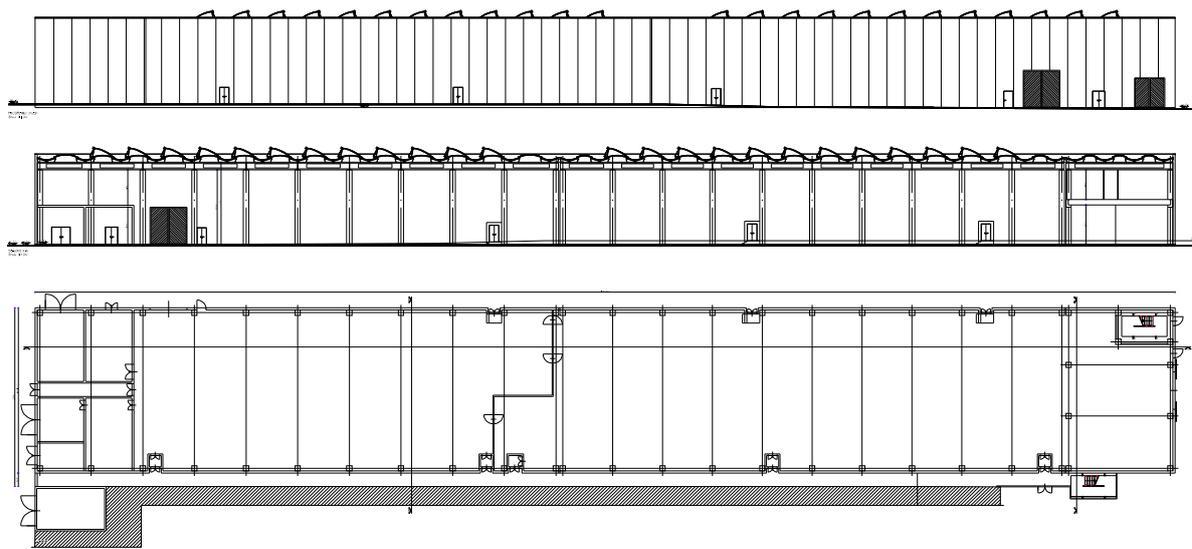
Pianta, sezione e prospetto longitudinale fabbricato A
